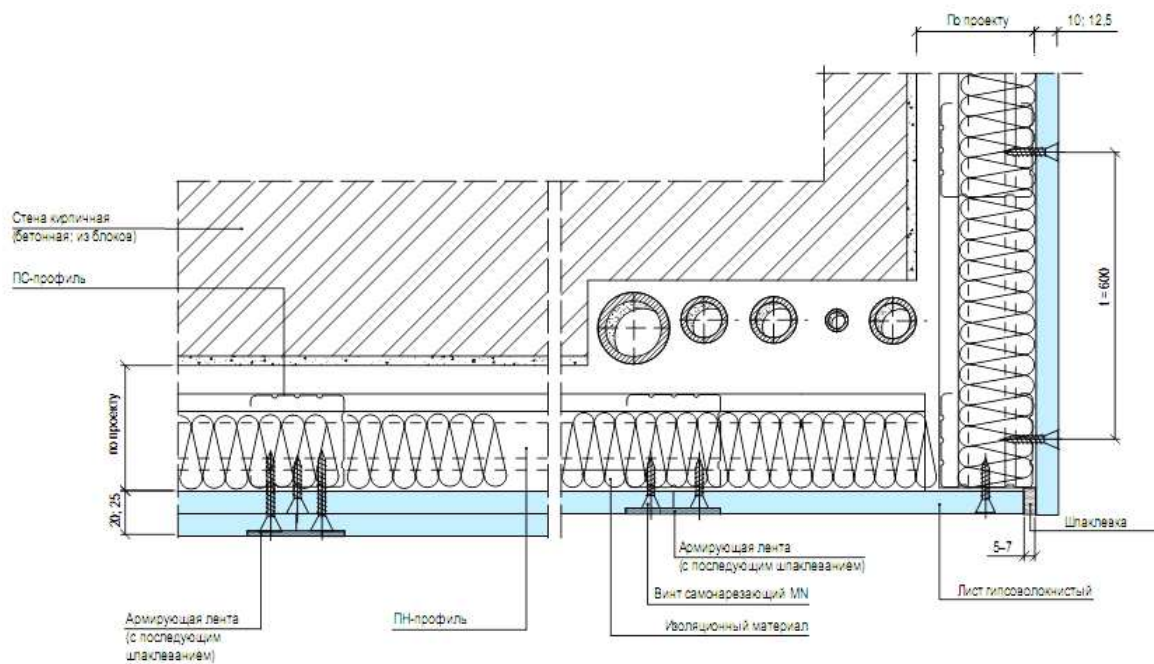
Конструктивное решение обрешетки трубопроводов, размещенных вдоль капитальной стены (а), перегородки (б)
